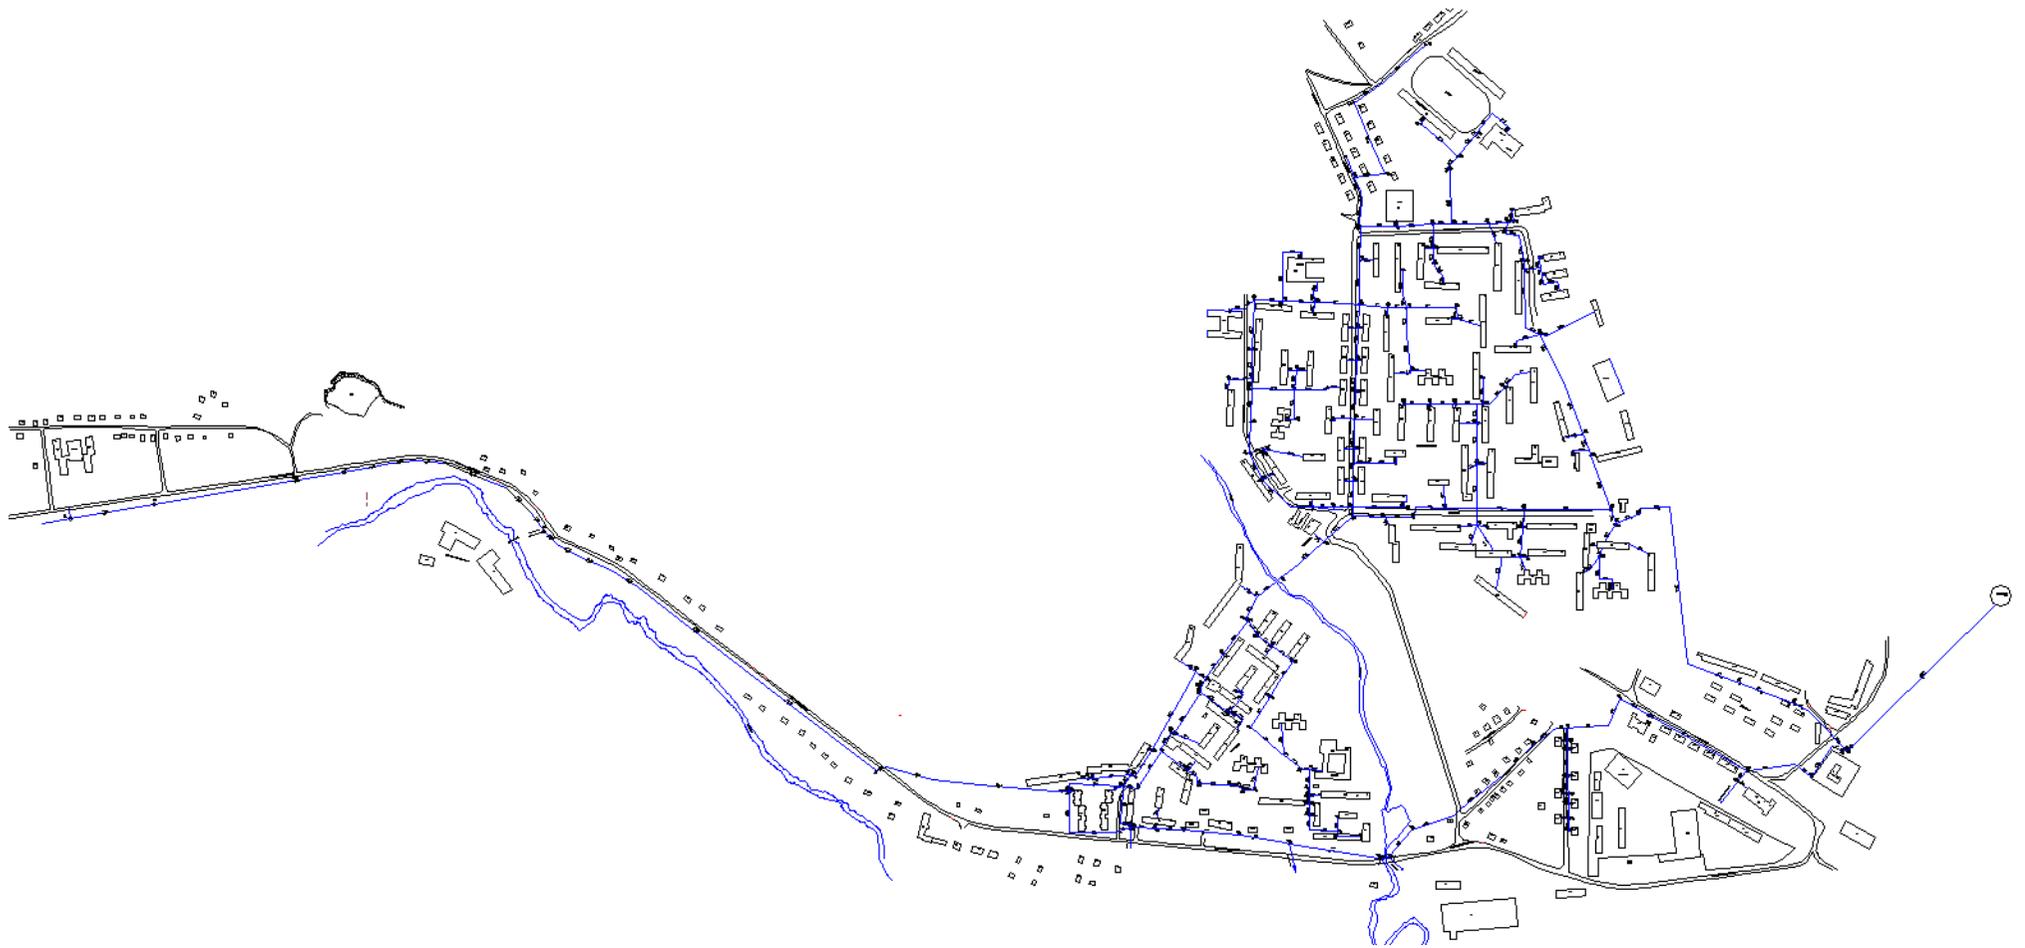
План водопроводной распределительной сети от насосной водохранилища «Нежданка» г. Дальнегорска
